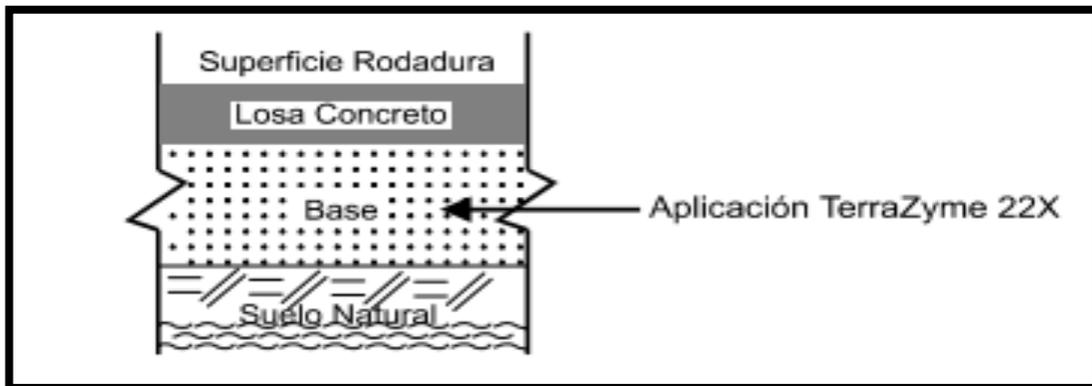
Aplicación de TerraZyme en pavimentos con losas de concreto. [53].
